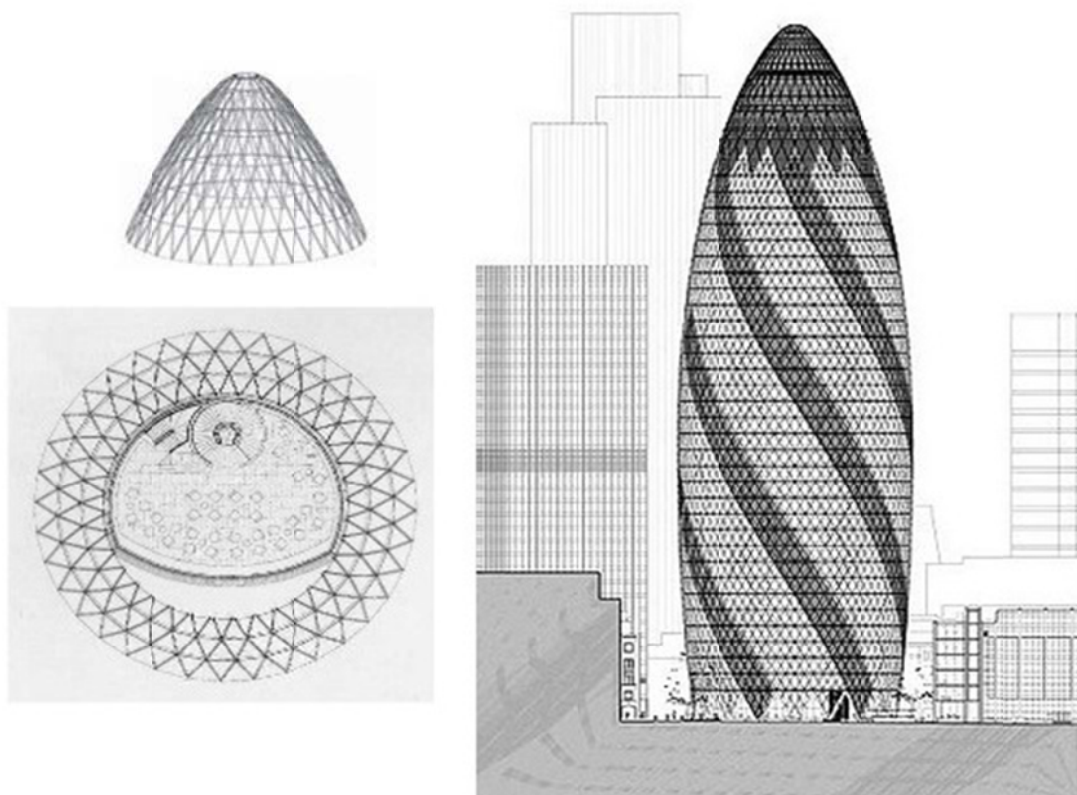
Torre Swiss Re en Londres de Norman Foster. Cúpula, plano de la última planta y alzado del conjunto.
